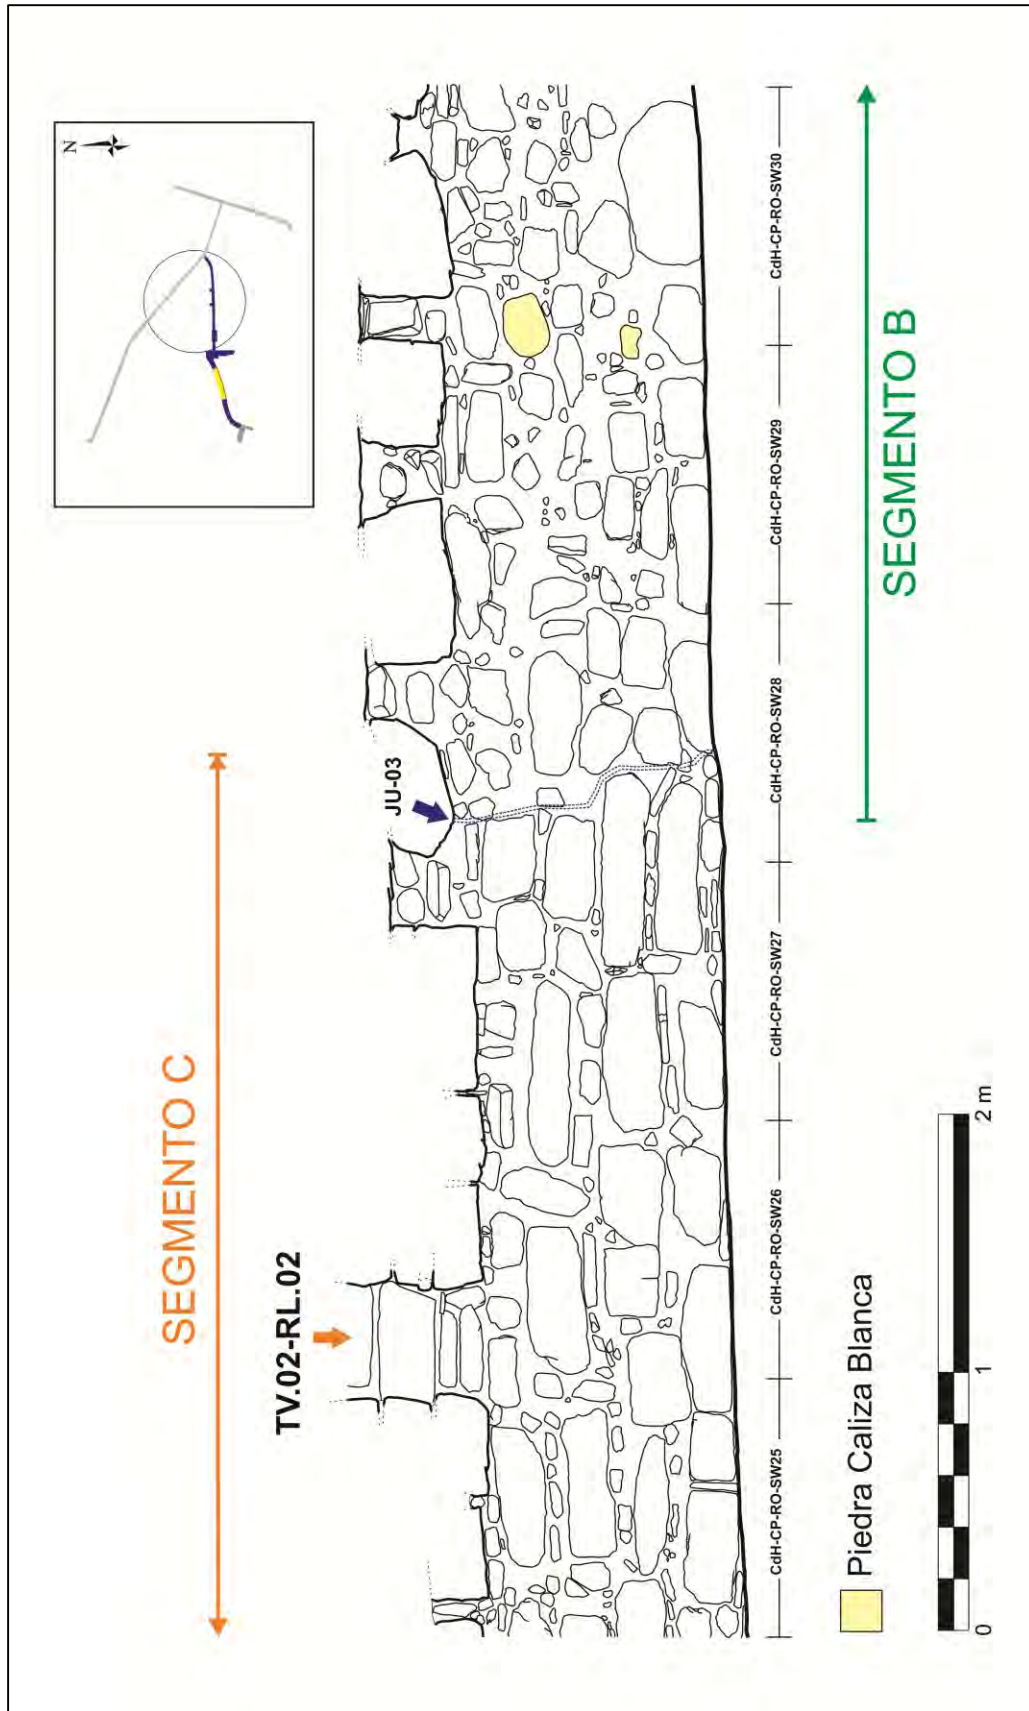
Dibujo de la pared RL.02-S. Detalle del cambio arquitectónico por medio de la junta de pared JU-03.
